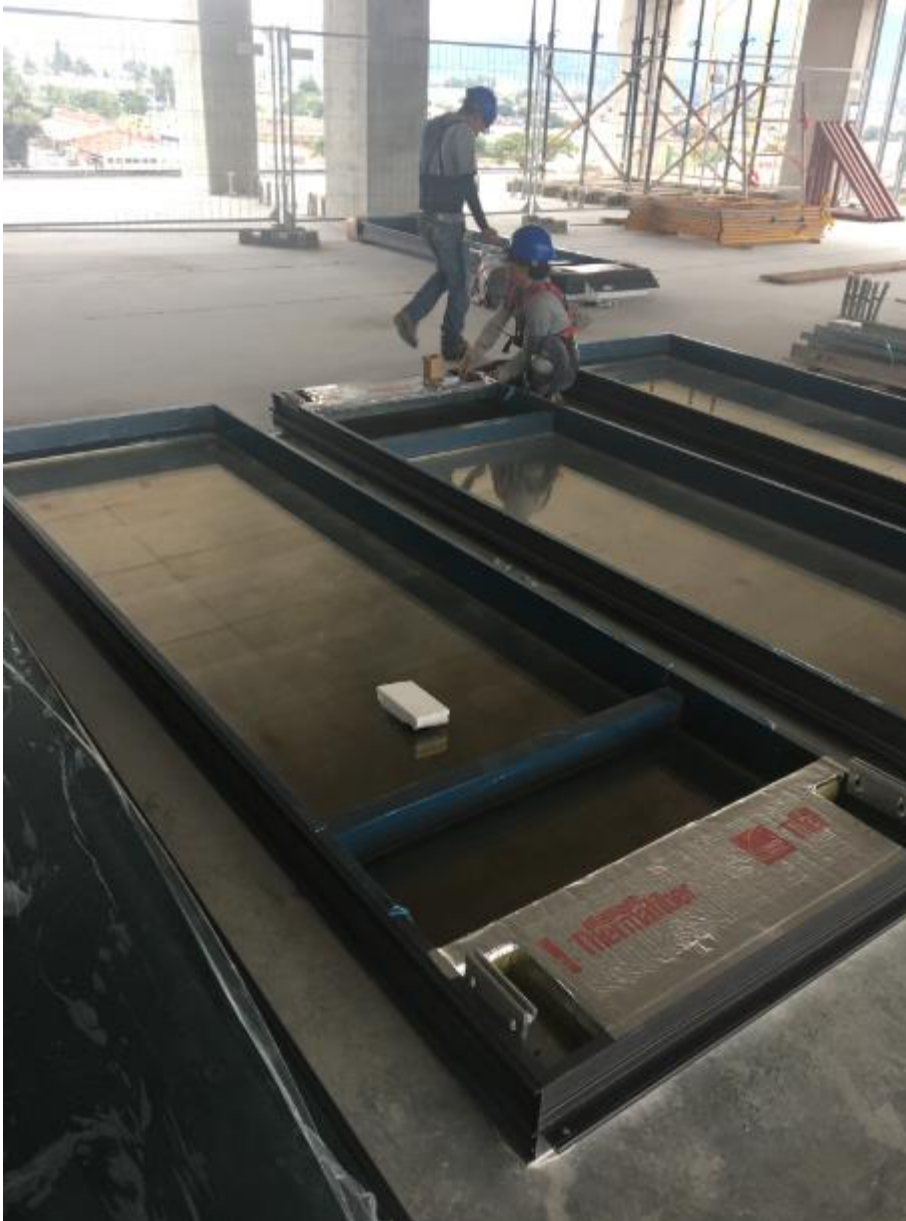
Panel armado para instalación en obra. Fuente: Propia (2019)
